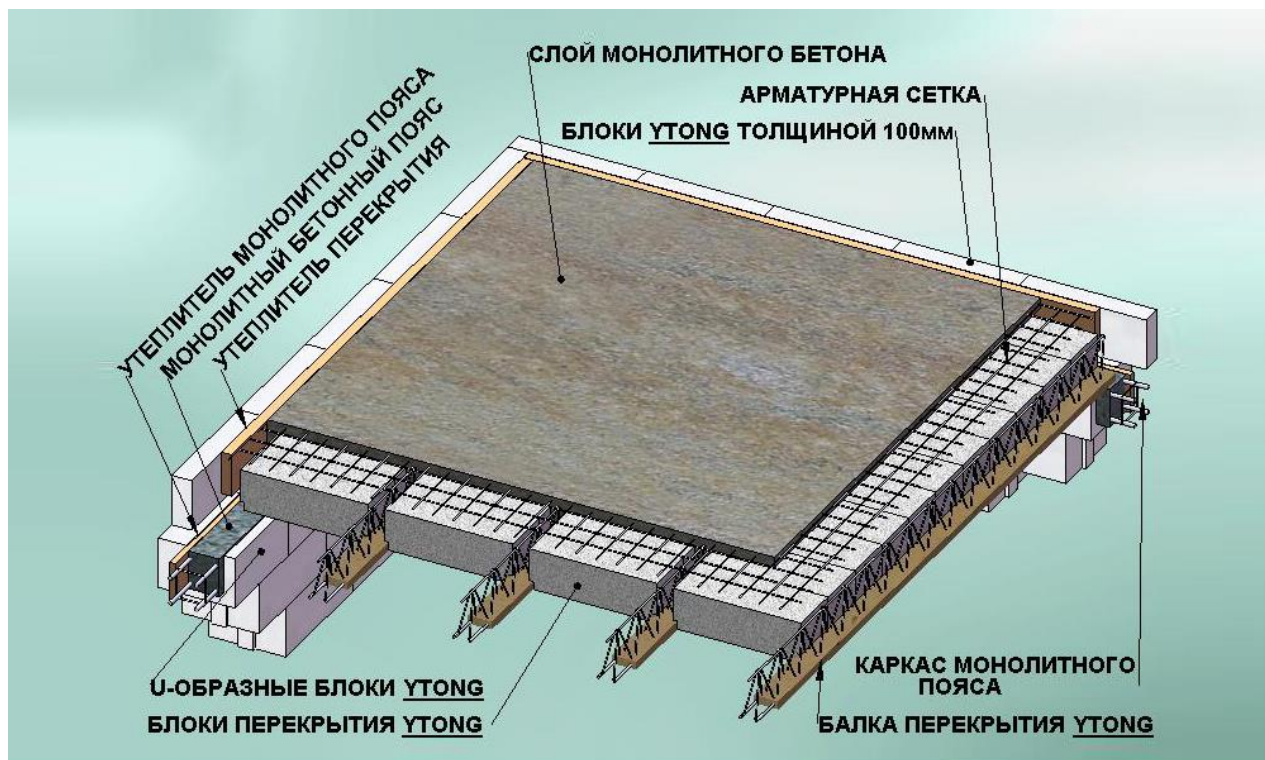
Строение сборно-монолитного перекрытия из газобетона
